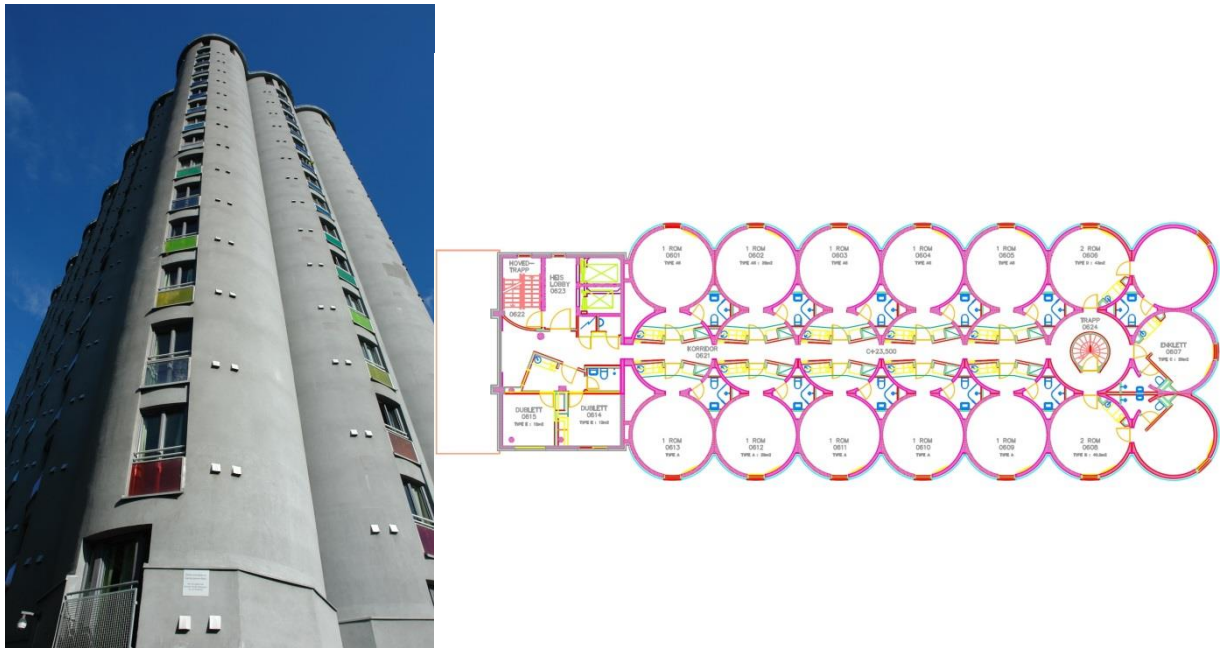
Элеватор в г. Осло, Норвегия. Фасад здания. Типовой план этажа.
